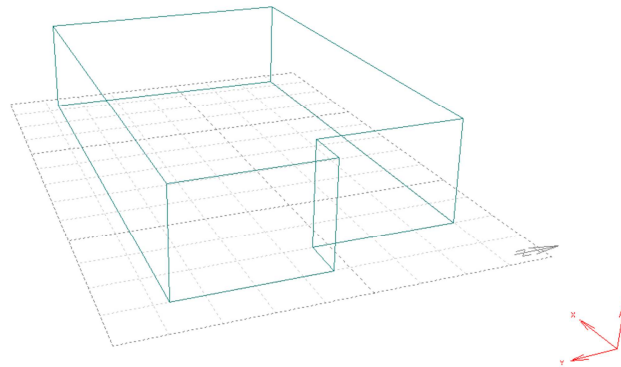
Modelo de Paredes Perimetrales de la vivienda propuesta en ECOTECT®
